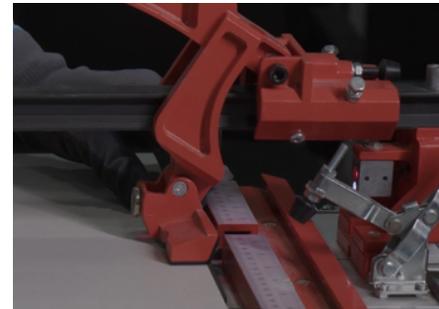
Coloque la zapata del rayador al inicio de la pieza aplicando presión.
